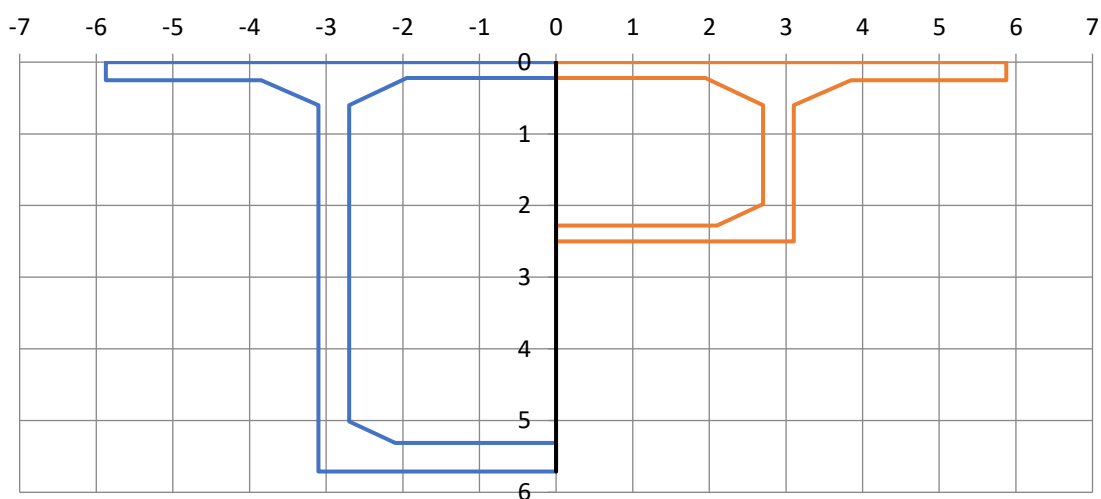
Section transversale sur appui et à mi-travée d'un pont à caisson à inertie variable
